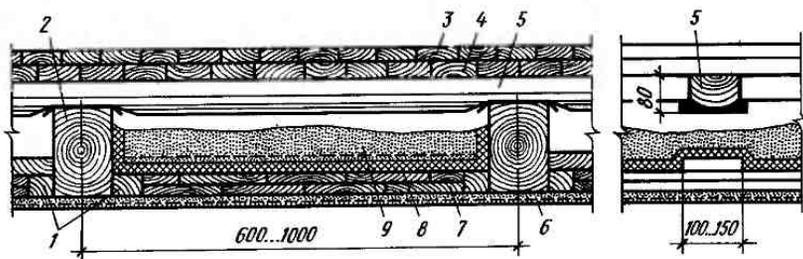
Конструкция деревянного междуэтажного перекрытия:
